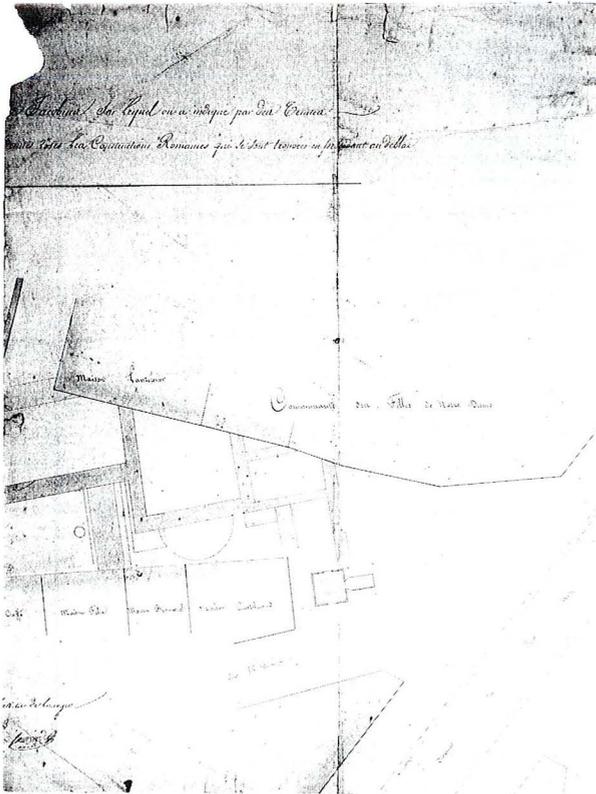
Plan dressé par l'architecte FAYETTE, en 1843-1845, des vestiges retrouvés place des Jacobins.
